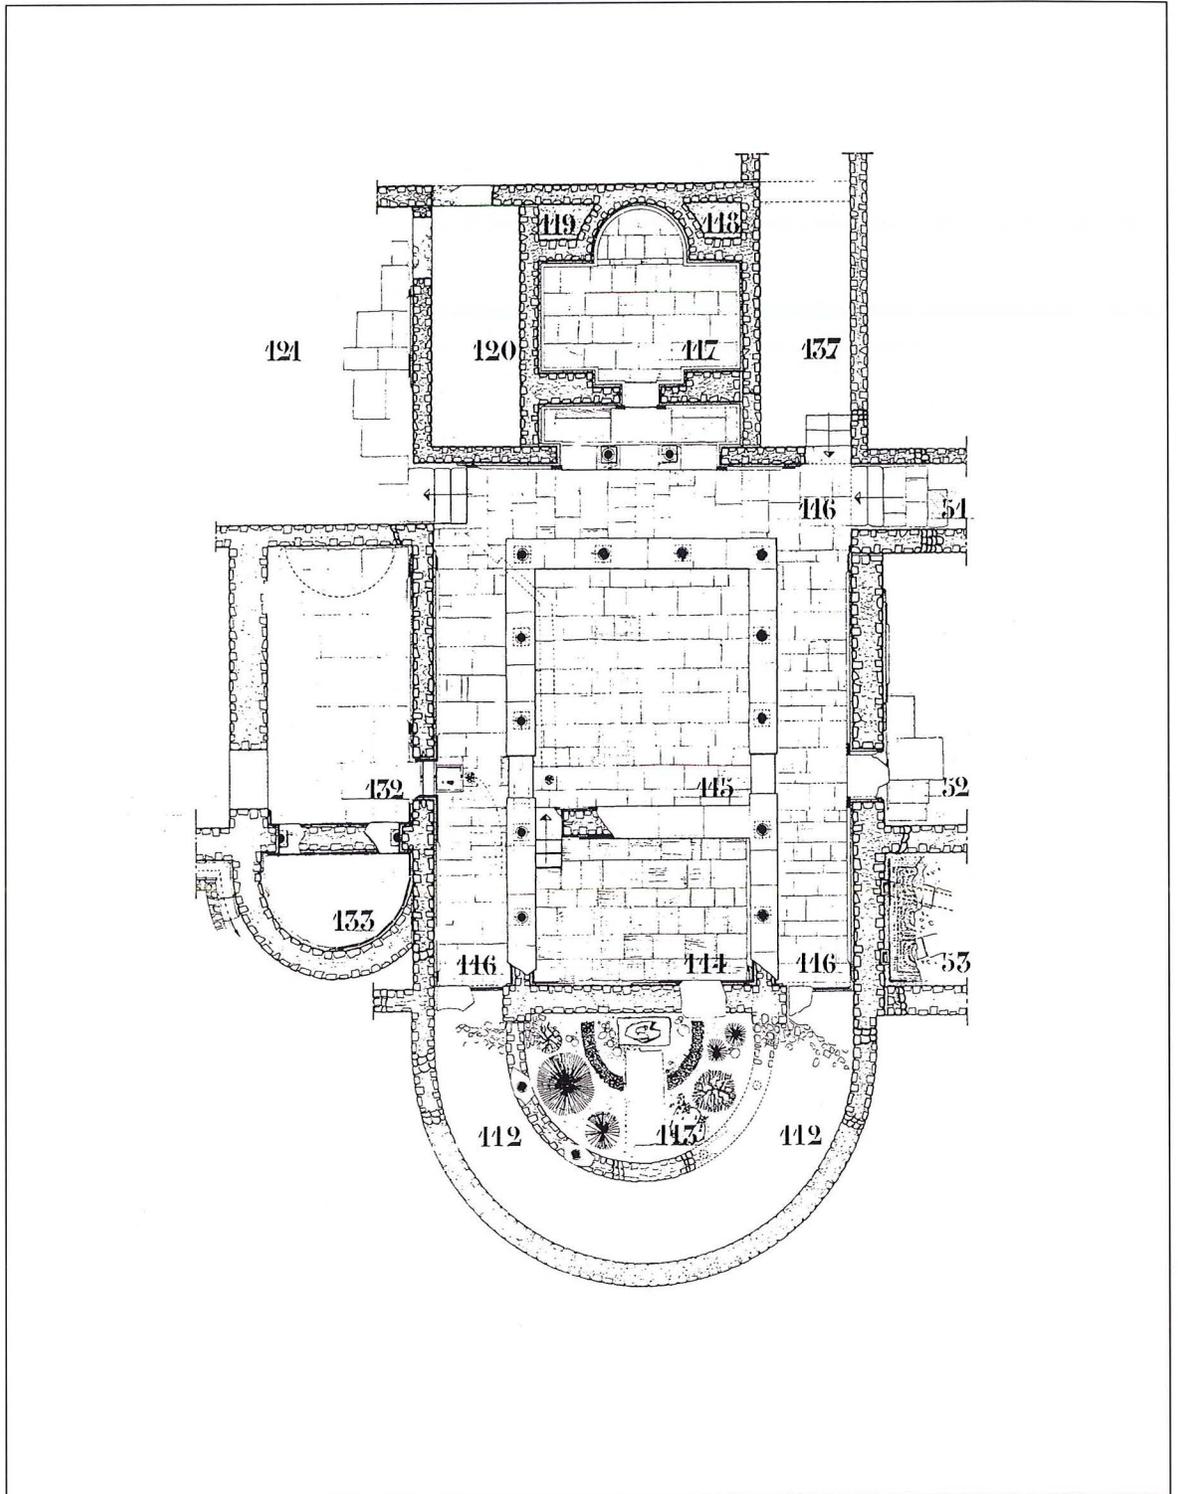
Plan du péristyle par G. Fouet (Fouet, 1969, 78).
